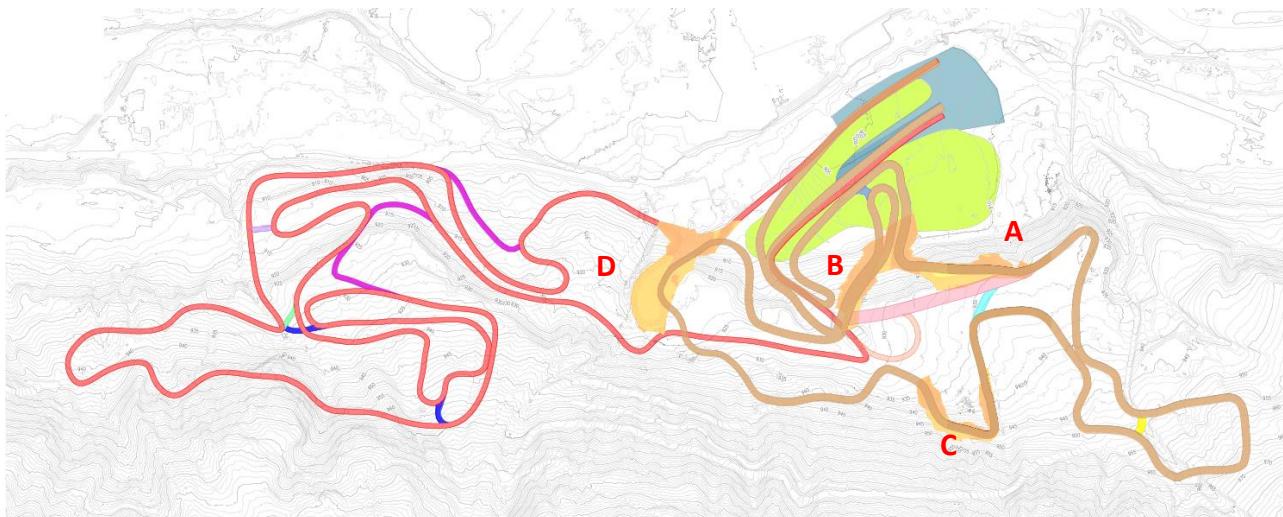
Planimetria sterri e riporto con indicazione zone di intervento - scala a vista
